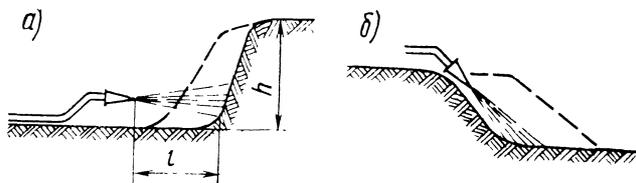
Схема разработки выемок (карьеров) гидромониторами:
